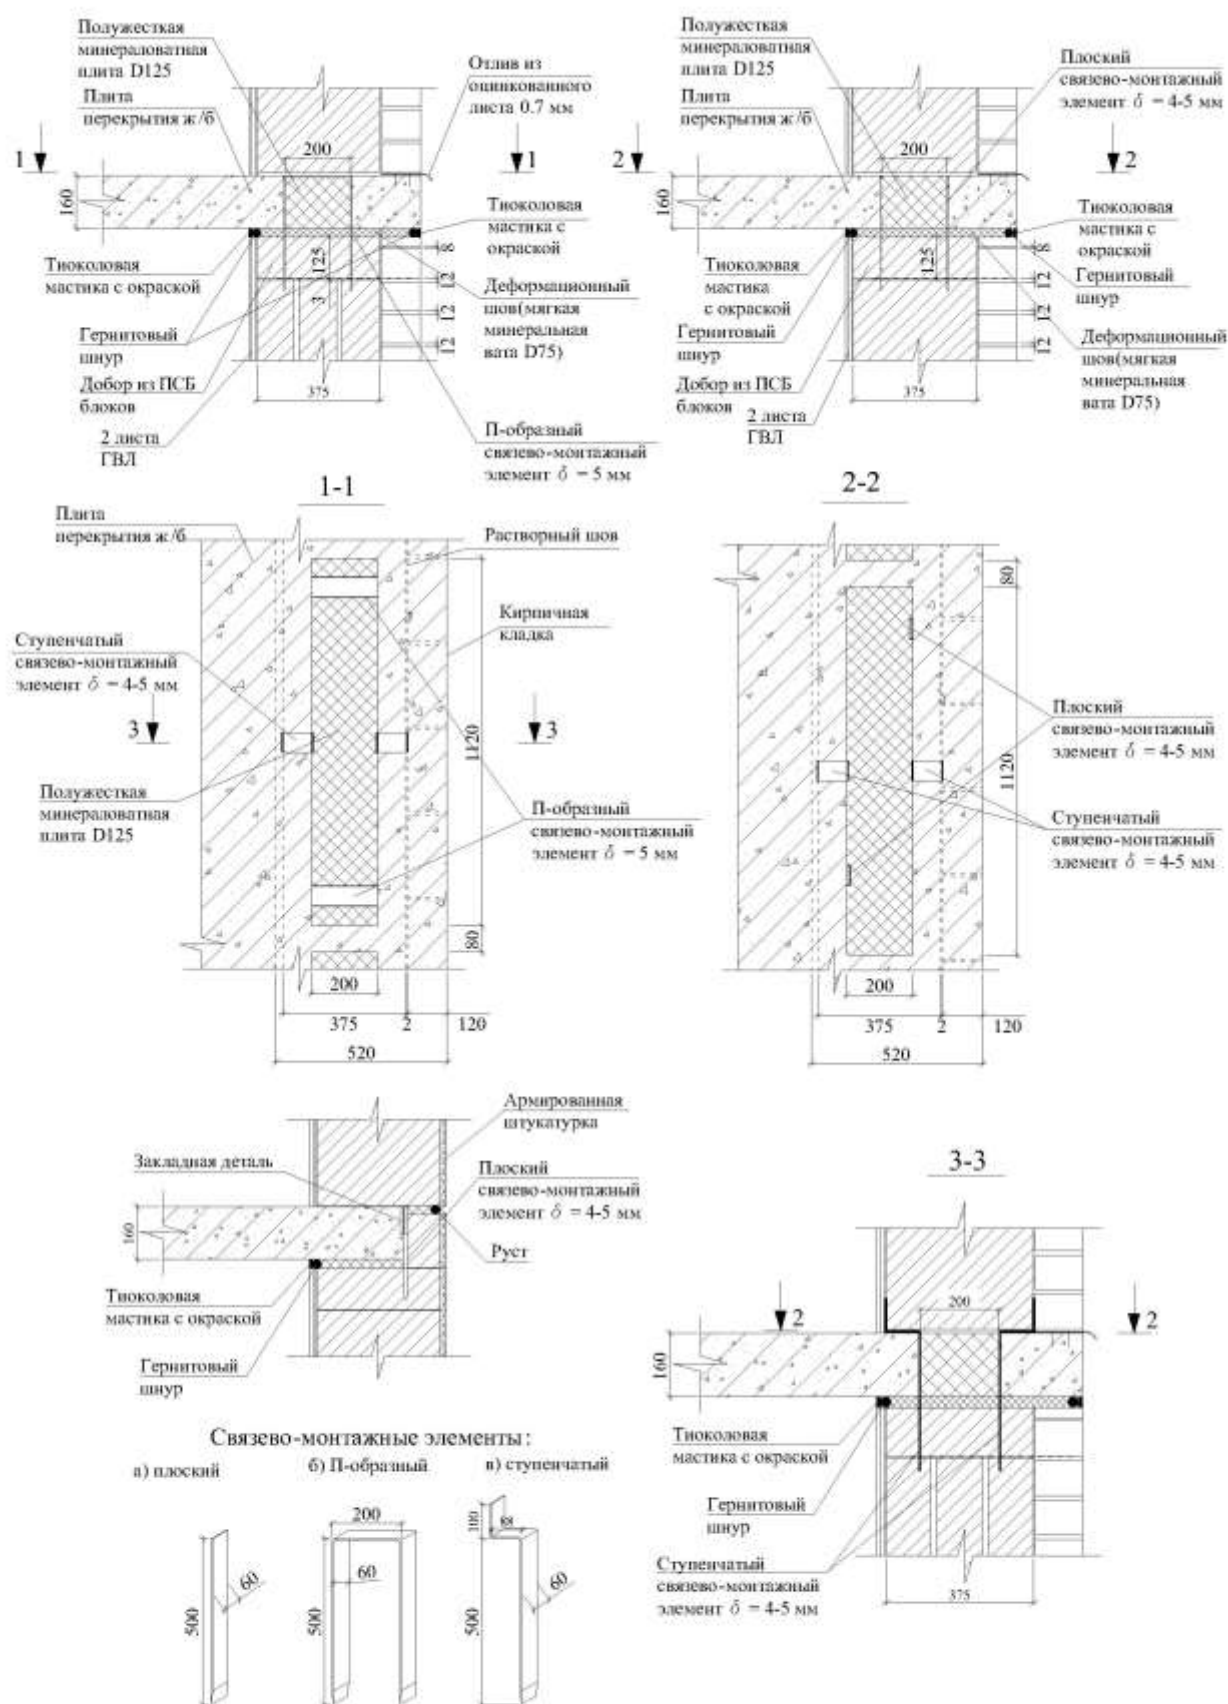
Крепление кладки из ПСБ блоков к железобетонным перекрытиям
